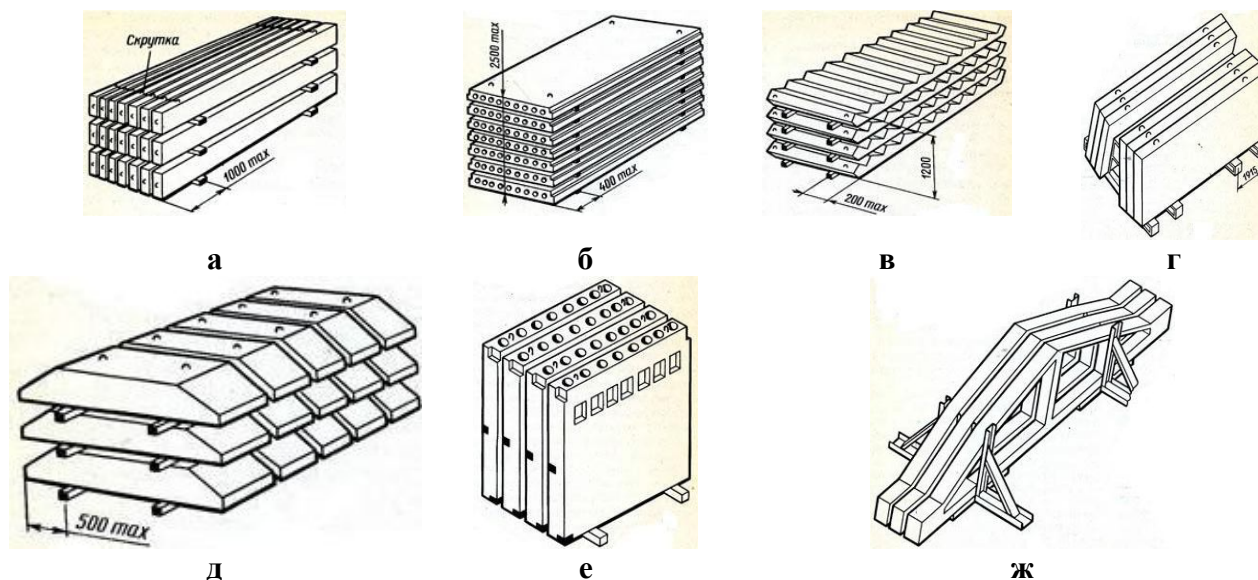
Складування збірних залізобетонних конструкцій: а – прогони; б – плити перекриття; в – сходові марші; г – панелі стінові; д – подушки фундаментні; е – блоки вентиляційні; ж – ферми
